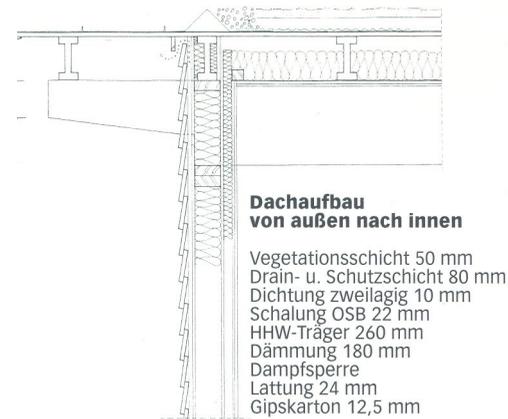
Ortgangdetail: Doppelsteg-träger als Sparren
